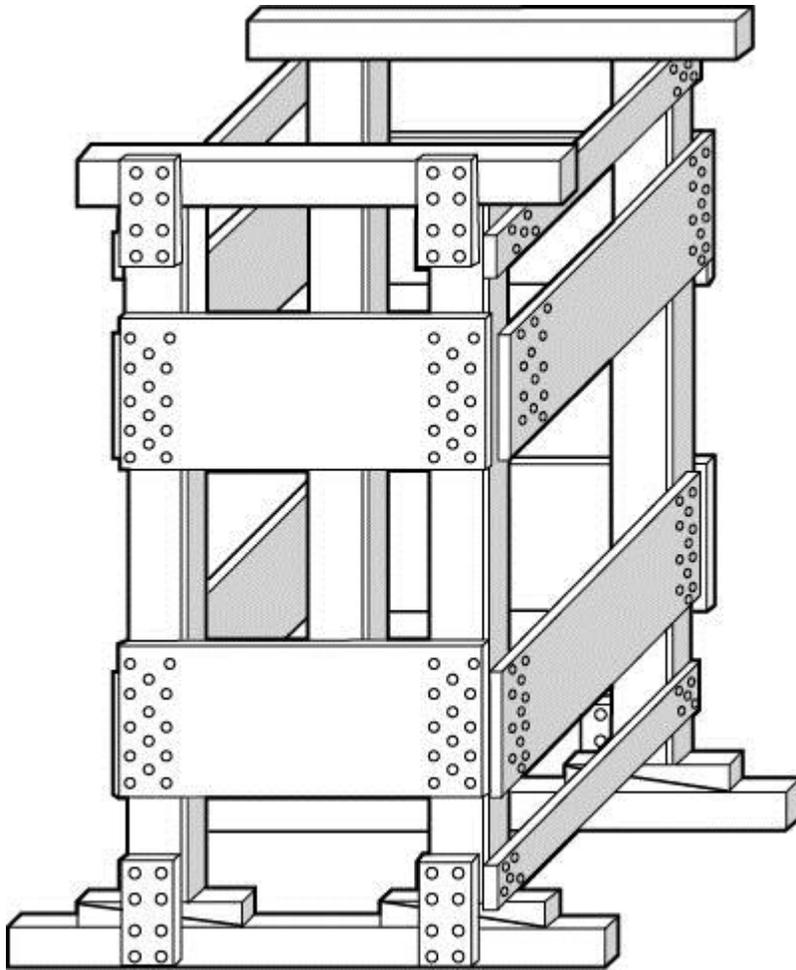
(c) Tipo inclinado Floor Shore 2.
